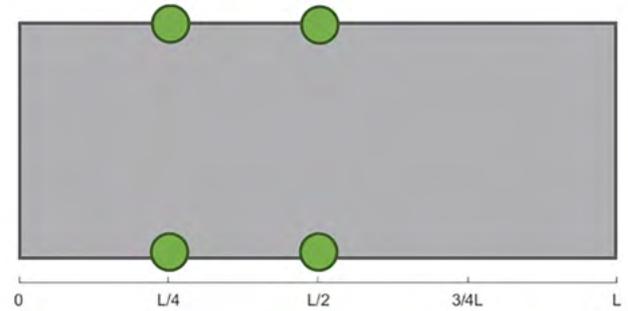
Ubicación realista en planta del tablero de los puntos de medida mínimos.
